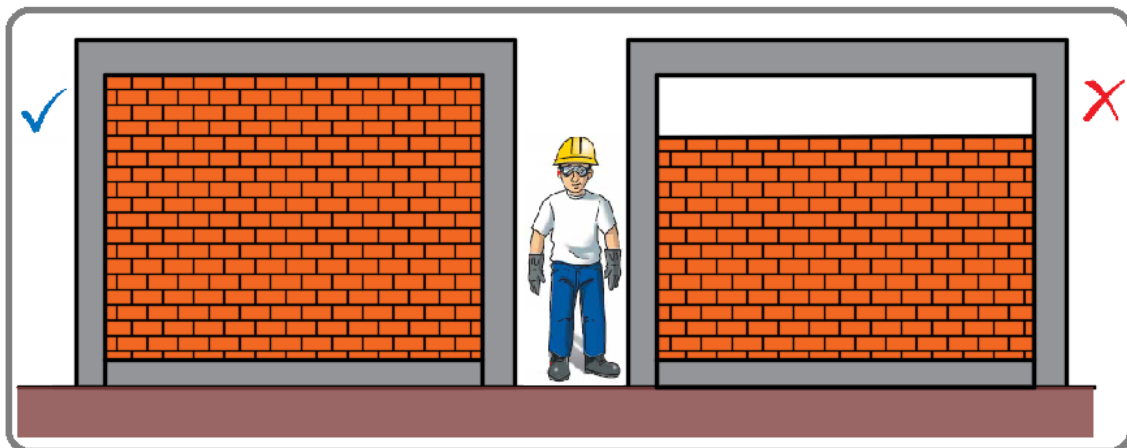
Representación del adecuado levantamiento de muros, para evitar efecto de columna corta.
